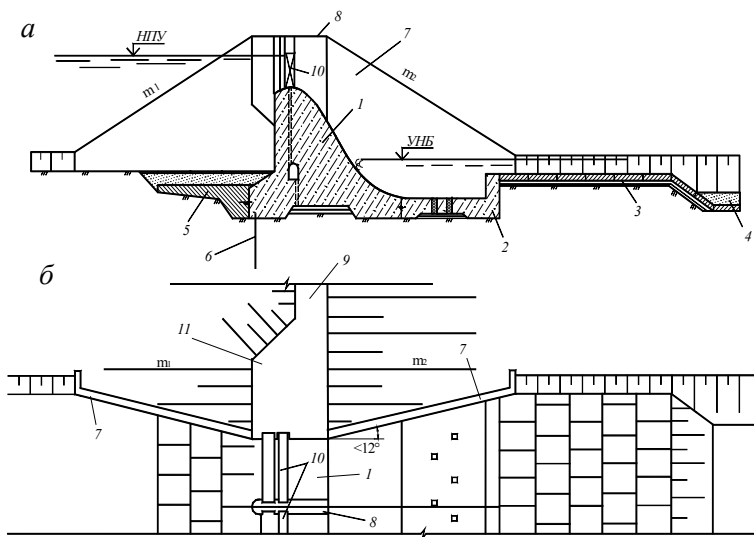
Схема бетонной водосливной плотины на нескальном основании: *а* – продольный разрез; *б* – план: 1 – водослив; 2 – водобой; 3 – рисберма; 4 – предохранительный ковш; 5 – понур; 6 – шпунт; 7 – сопрягающие устои; 8 – быки; 9 – земляная плотина; 10 – затворы; 11 – монтажная площадка
